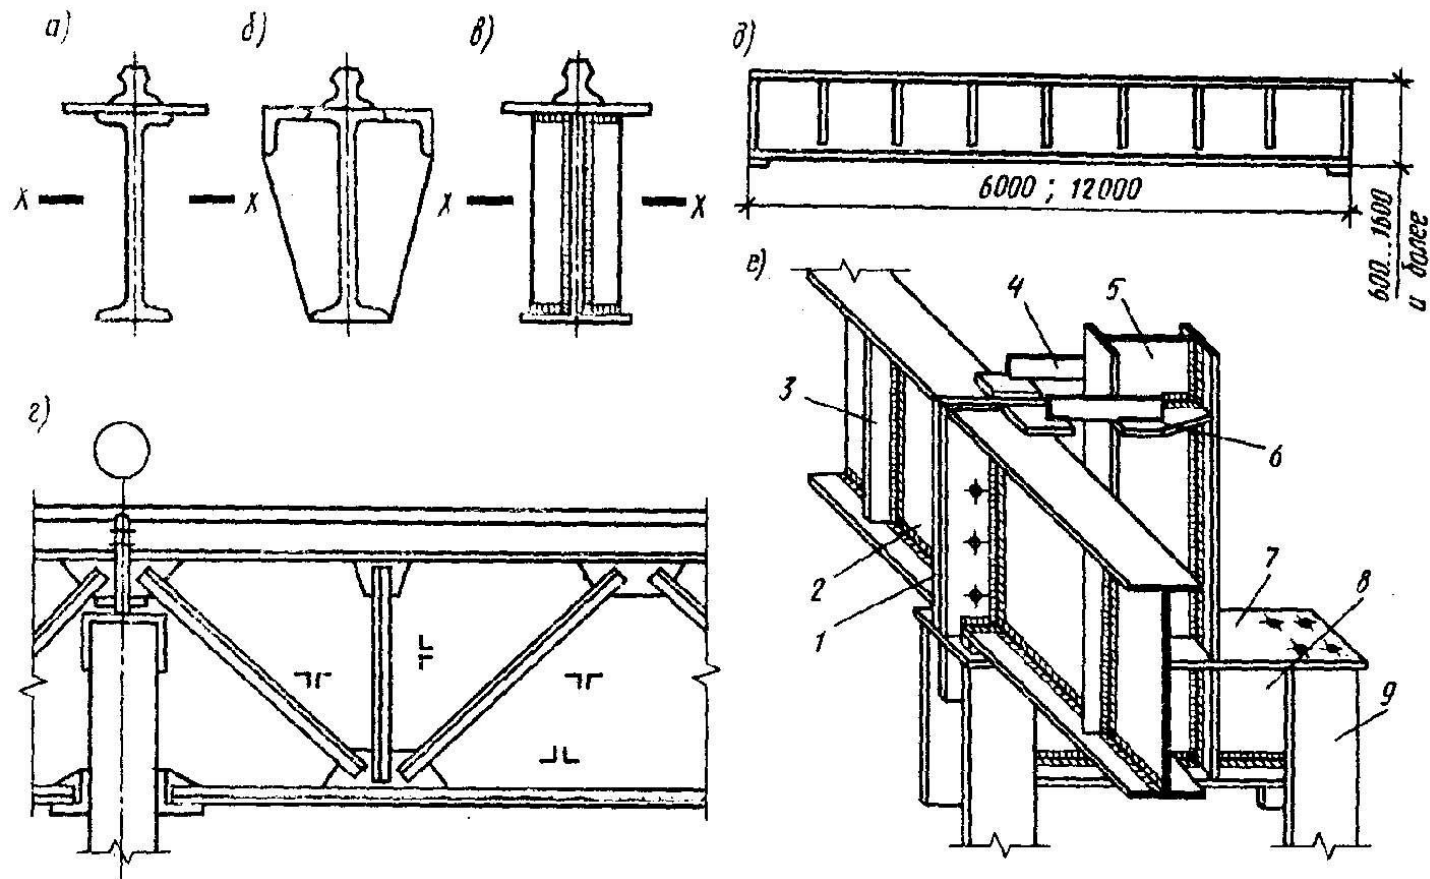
(продолжение)– Стальные подкрановые балки
